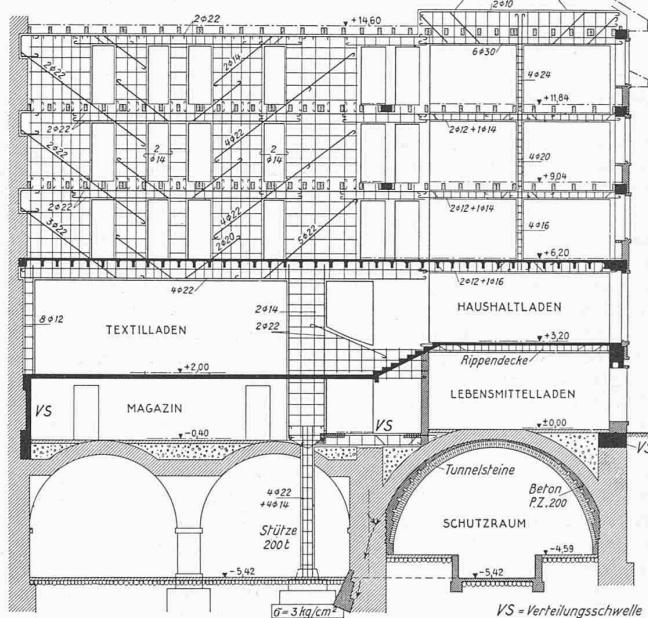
Innere Tragwand in Eisenbeton. — Masstab 1:250
